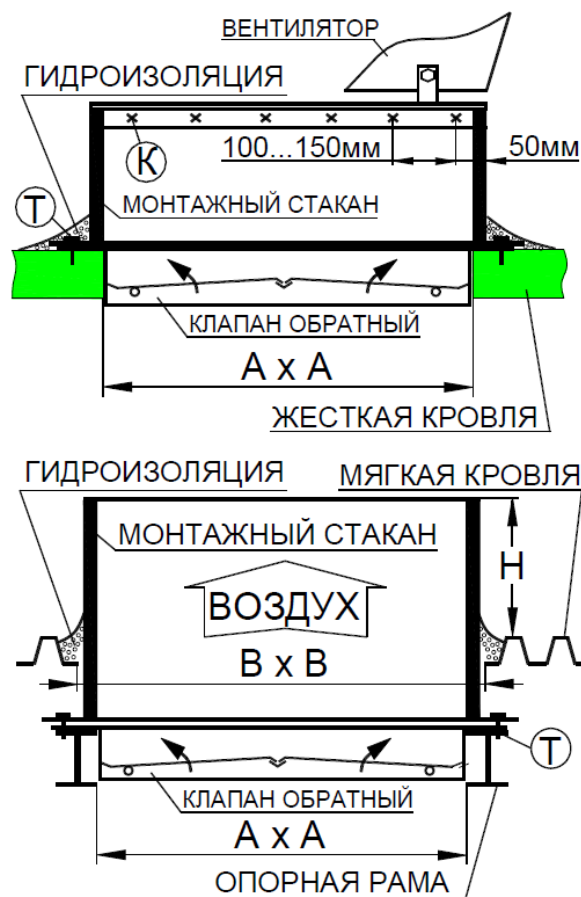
Монтаж на жесткой и мягкой кровле
